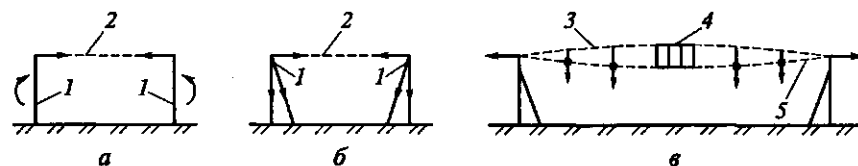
Схемы распределения нагрузок в вантовых конструкциях:
